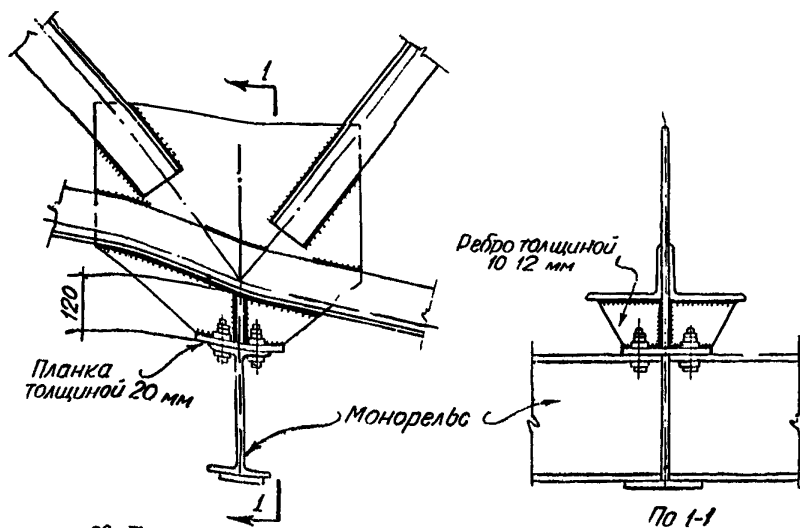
Пример конструкции узла наклонного нижнего пояса в мест подвески продольного монорельса
